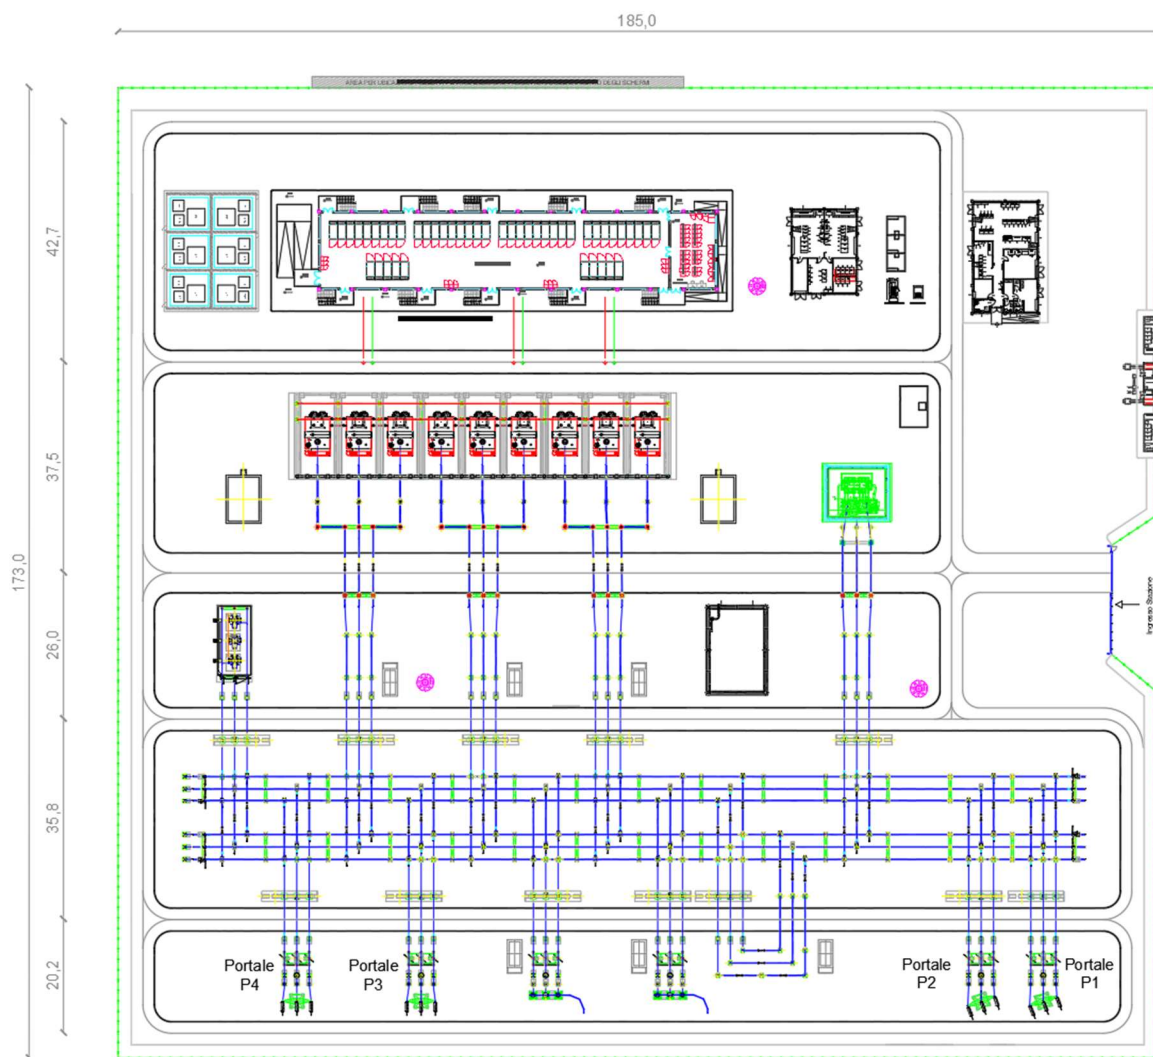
Planimetria elettromeccanica futura SE RTN 150/36 kV con raccordi alla RTN
